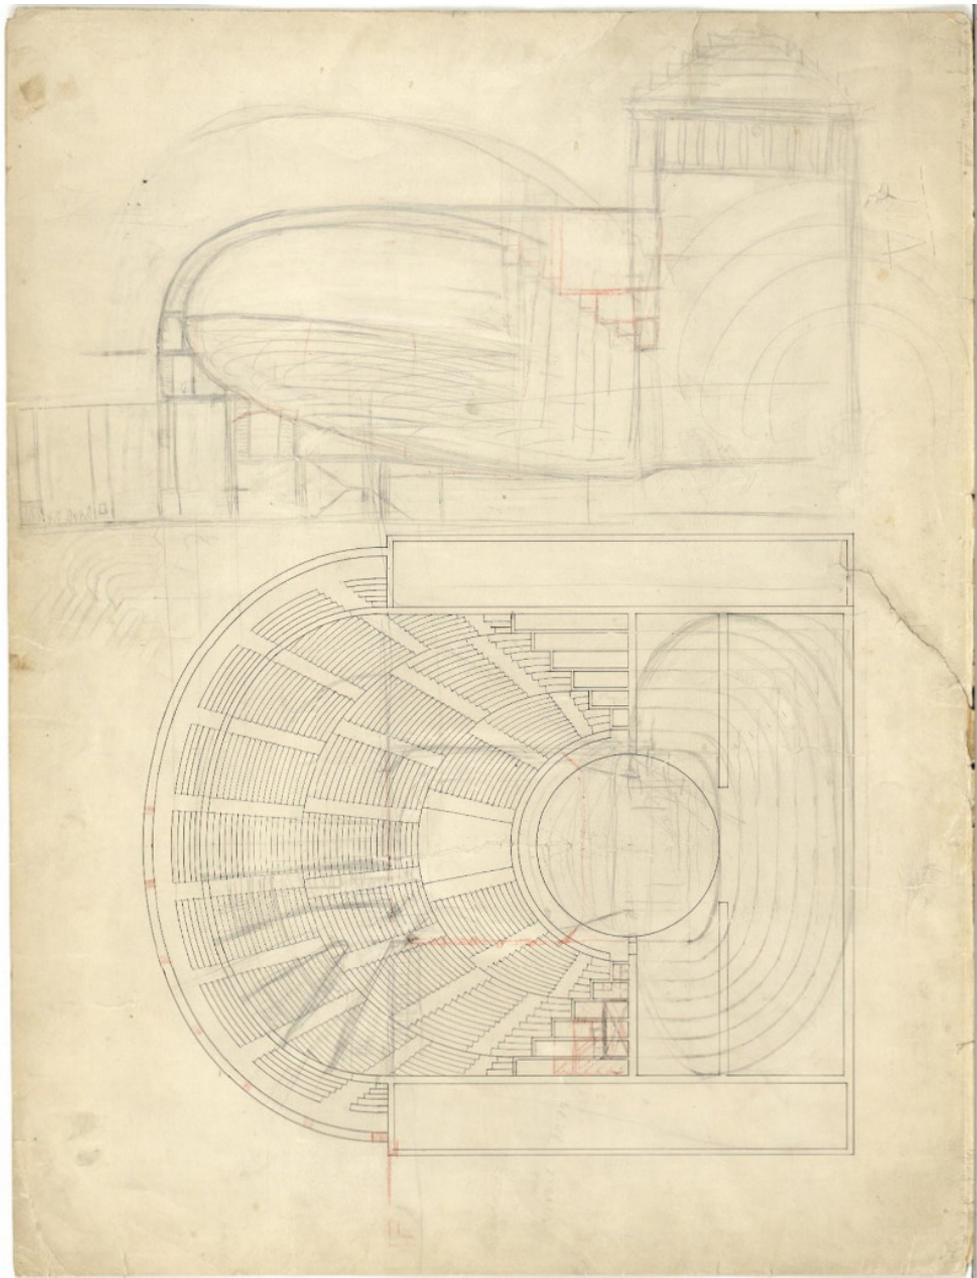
LOOS, Adolf. *Theater für 4.000 Personen III.*, Wien XIV, Märzpark, Grundriss, Schnitt. [Tinta y lápiz]. 1898, 1912. 664 x 504 mm. Teatro para 4000 personas. Planta y sección.
